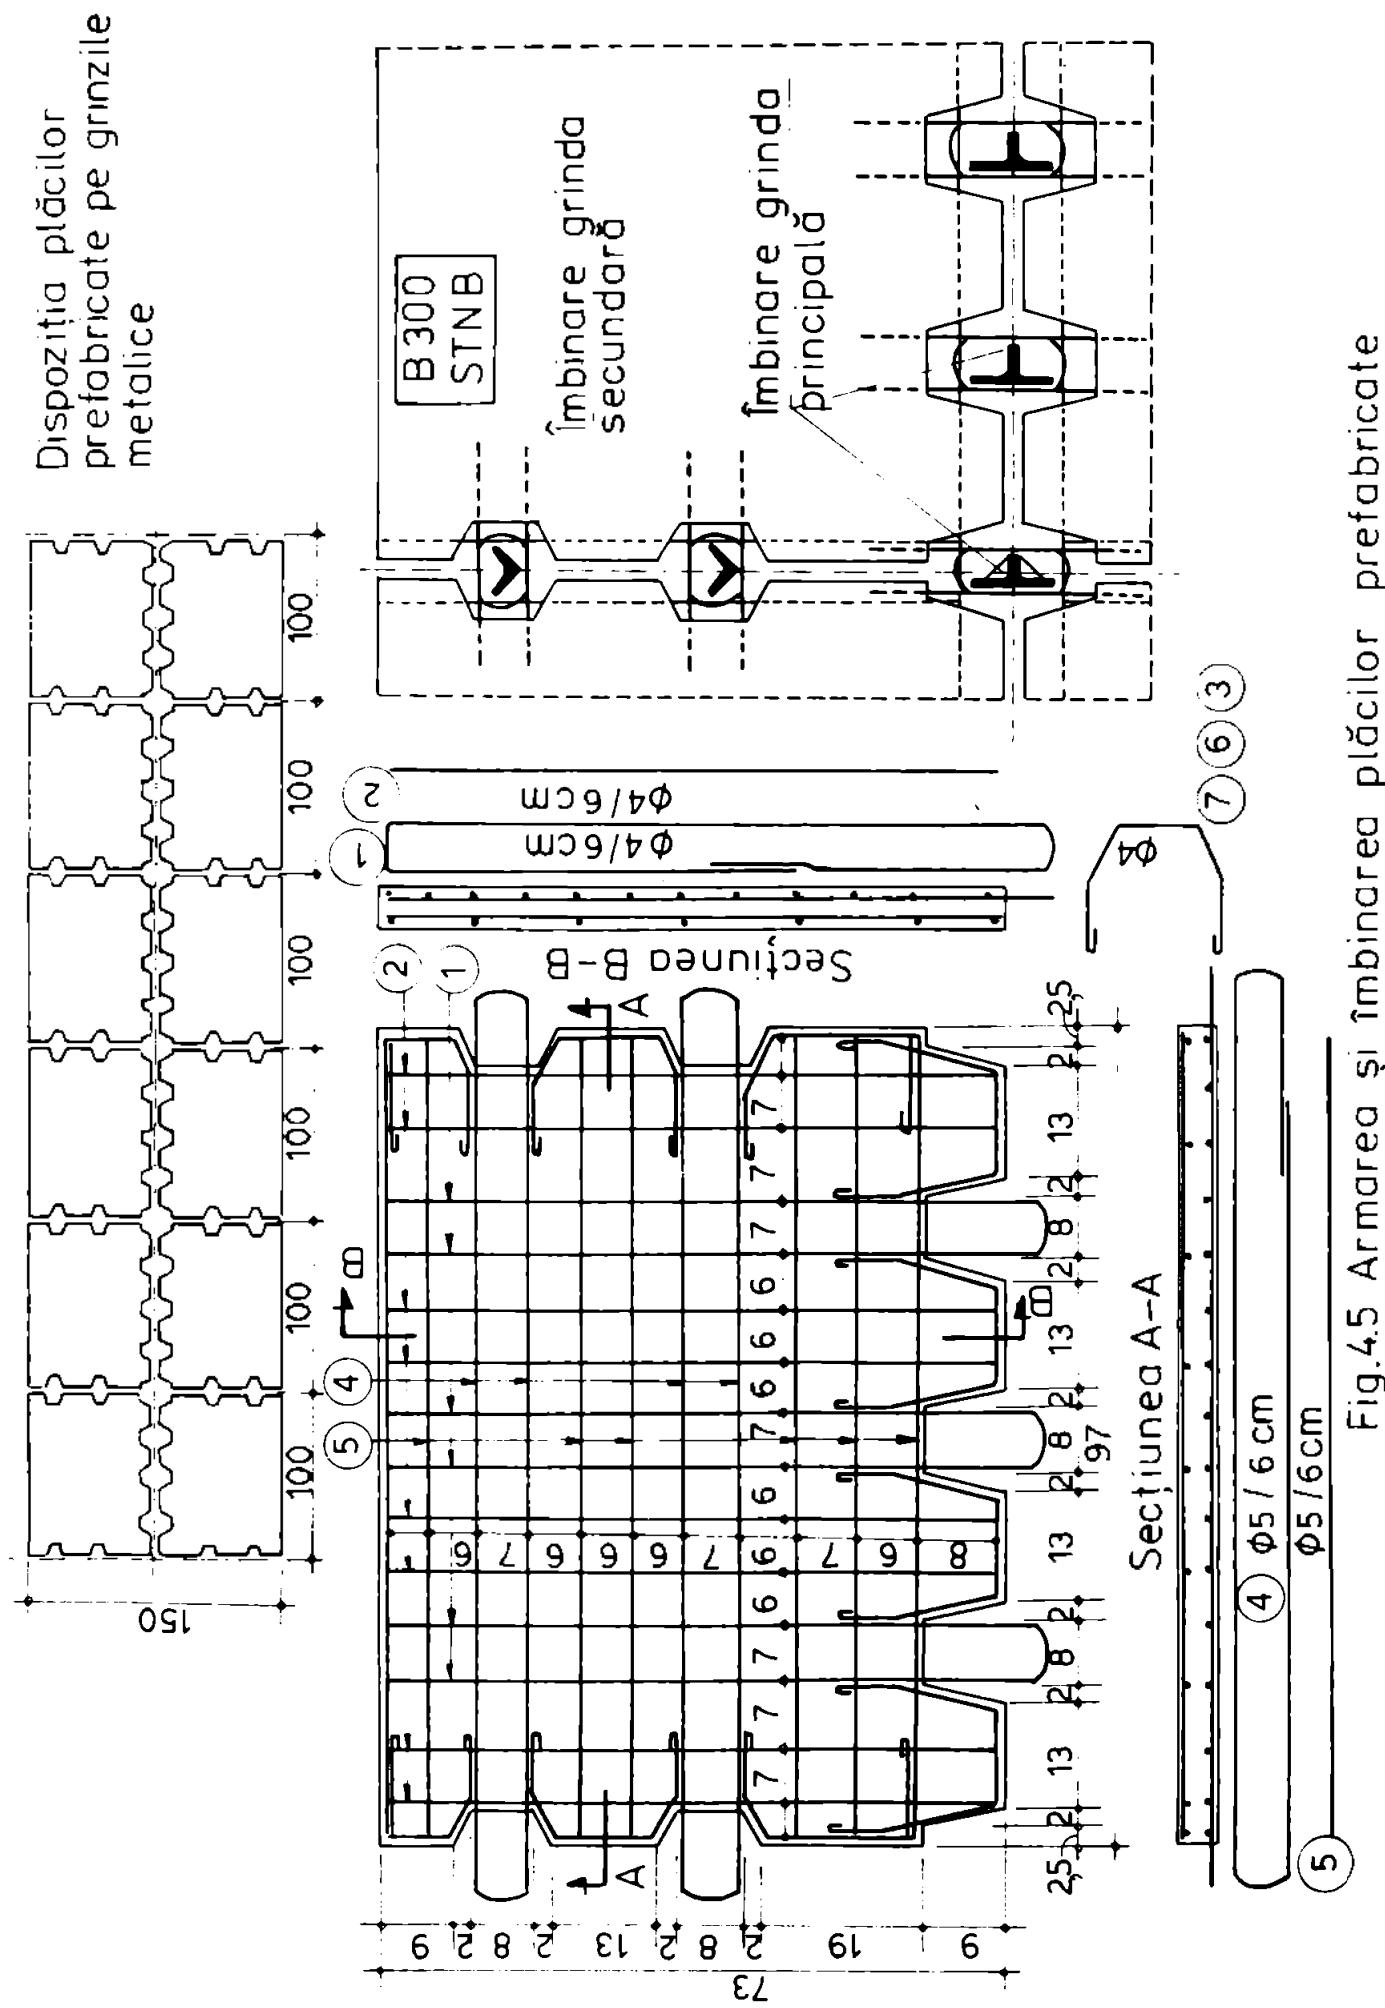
Armarea și îmbinarea plăcilor prefabricate
